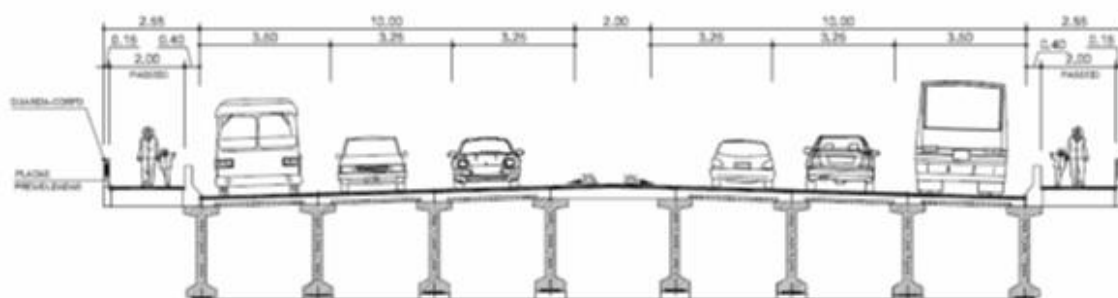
Perfil transversal da ponte sobre o Riacho do Cabral.
